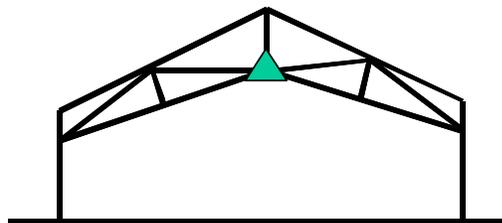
Invernadero de cristal para zonas frías con ancho medio de luz (9 m) y con estructura reforzada resistente a altas cargas de nieve (típicas de Europa del Norte y Japón)
